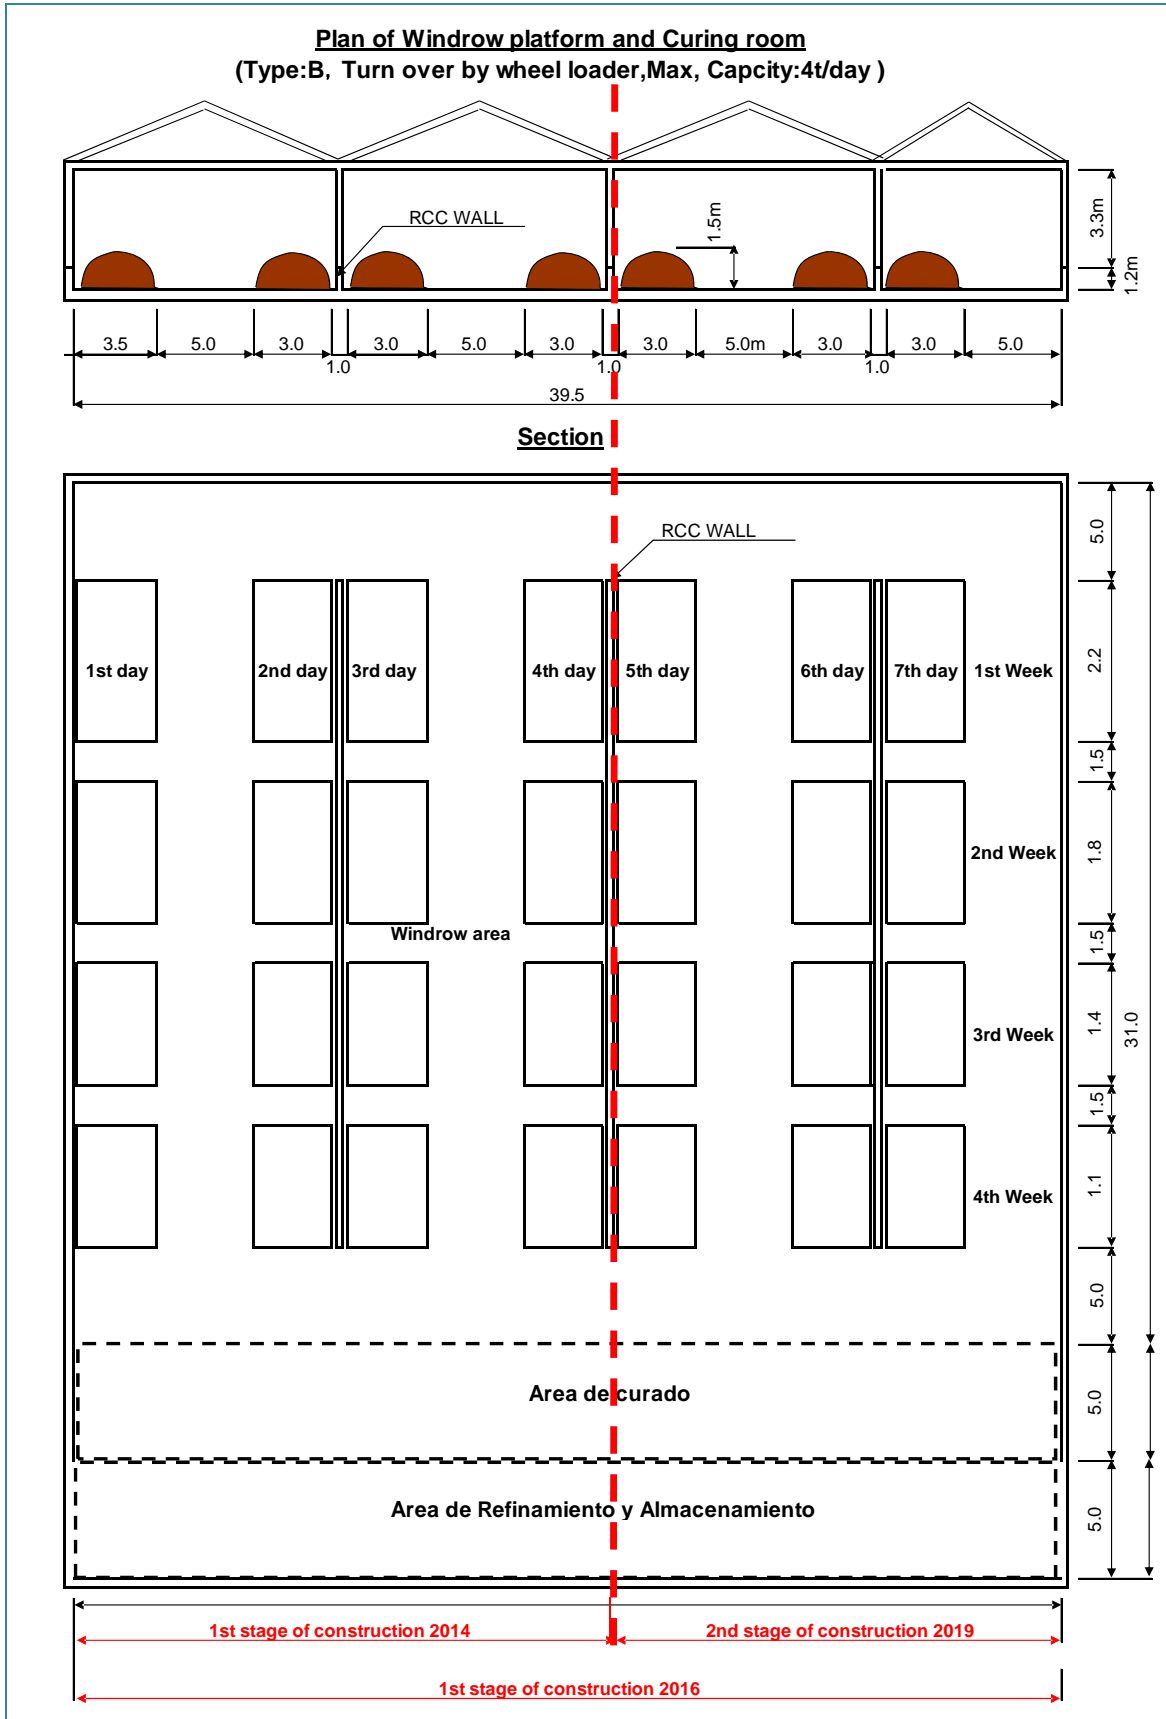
Tamaños de Plantas de Compostaje 4t
